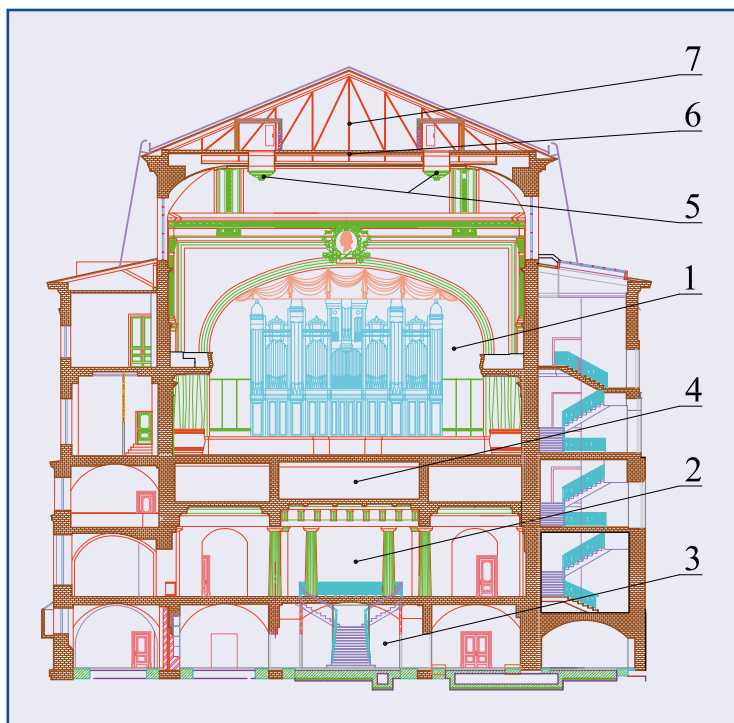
Сечение главного корпуса консерватории и Большого концертного зала:
